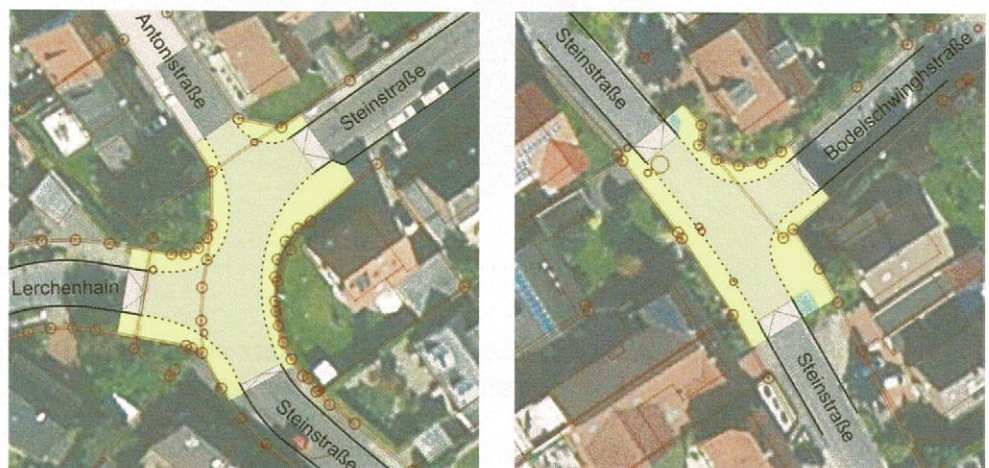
Entwurfsskizze für eine Teilaufpflasterung in Knotenpunktbereichen (li. Steinstraße/Lerchenhain/Antonstraße, re. Steinstraße/Bodelschwinghstraße)
